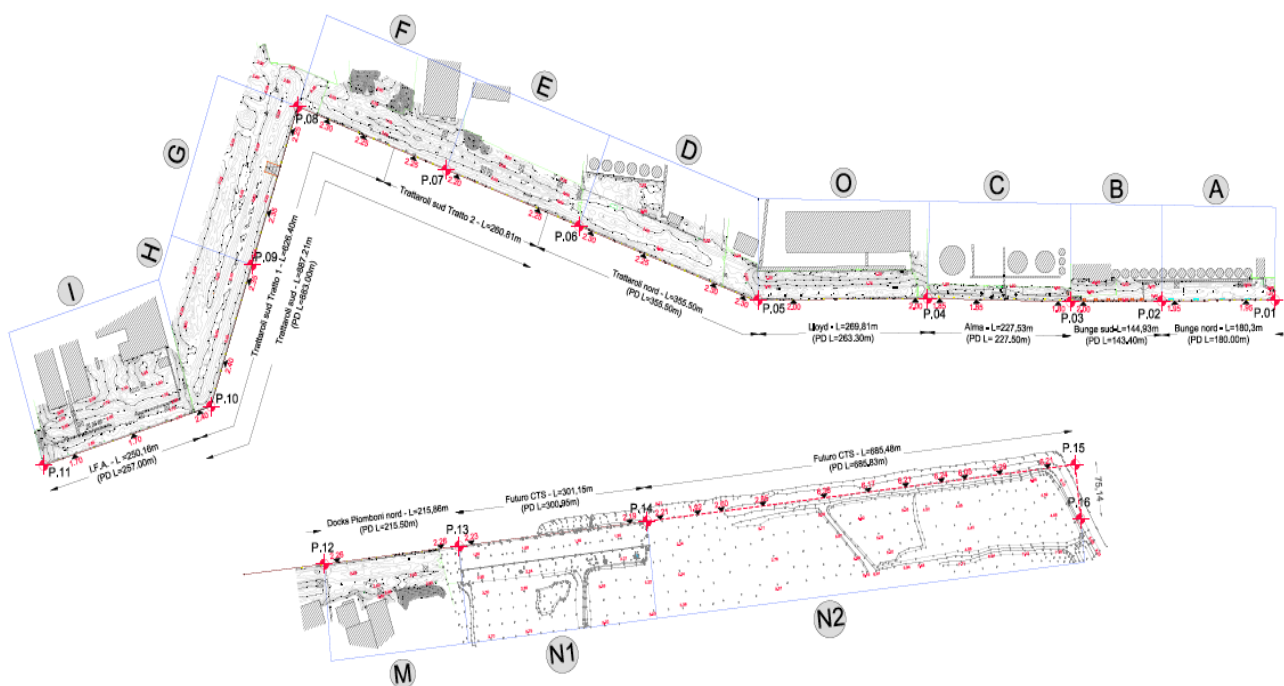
Planimetria inquadramento banchine: lunghezze delle banchine e dei cantieri (da rilievi 2020)
